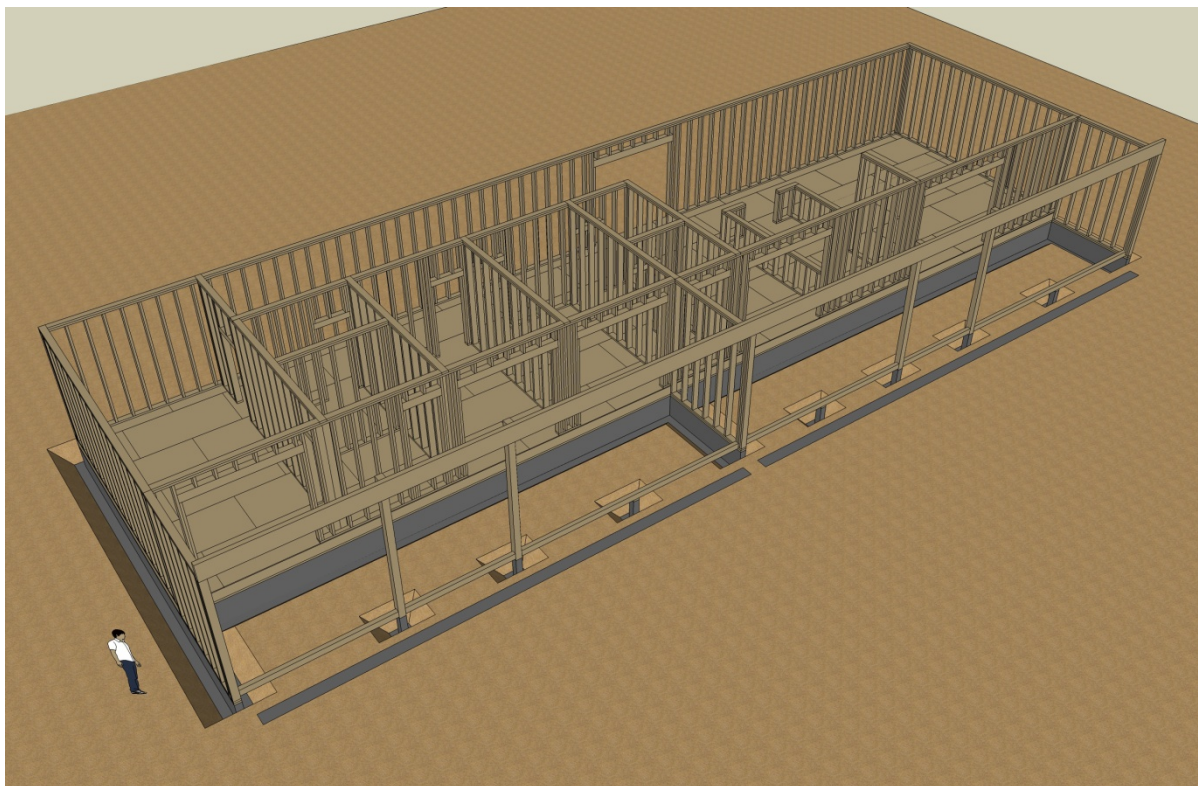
Montagem de viga, pilaretes e frechal dos alpendres.
